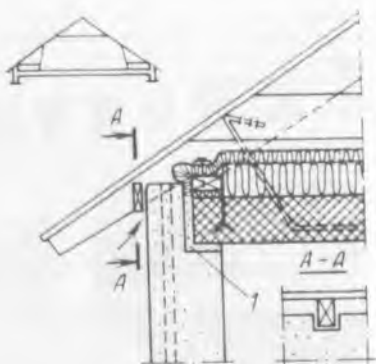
Соединение между не несущей ячеистобетонной стеной и верхним бетонным перекрытием с заделкой цементным раствором состава 1:3 (1)
